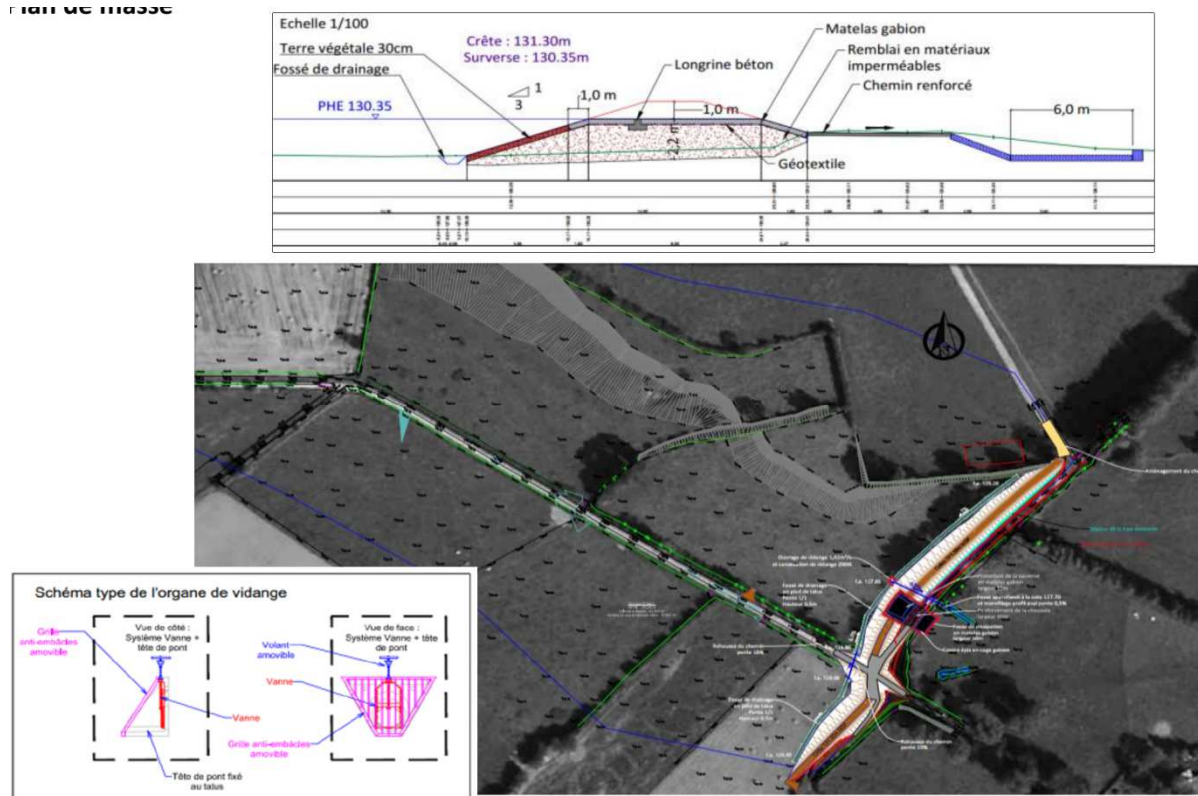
Extrait du plan de masse – Ouvrage E16-10
